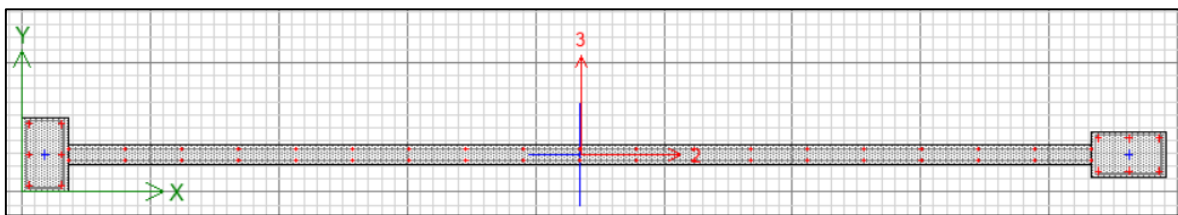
Armado de enchape, muro sin ventana, Vivienda A.
